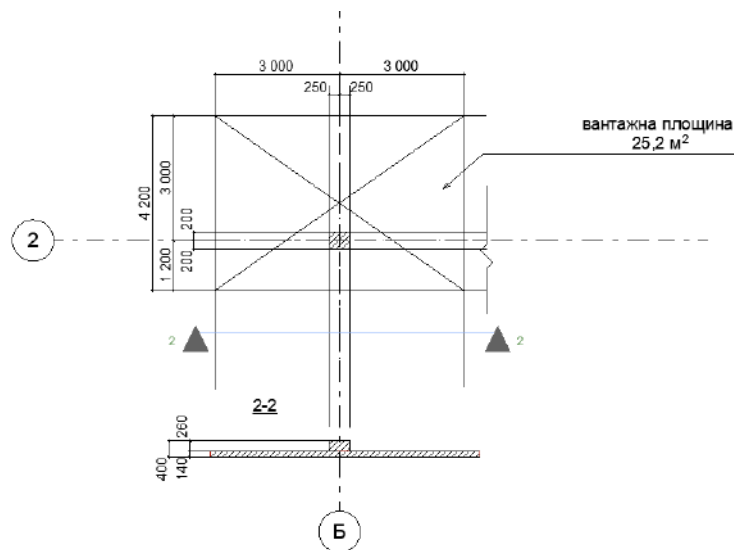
Вантажна площа 2-го поверху для стовпчастих фундаментів
